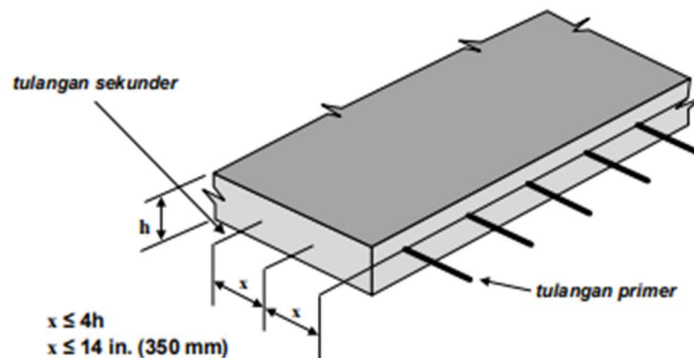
8 Tulangan Slab Dua Arah yang Dipikul oleh Girder, Balok, atau Dinding Beton Bertulang
